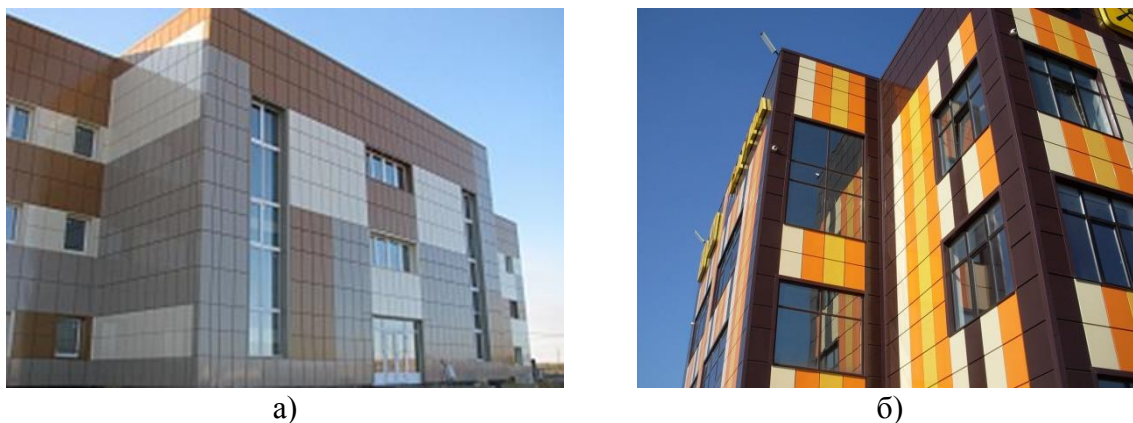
Фасады зданий: а) облицовка фасада сэндвич панелями; б) облицовка фасадными кассетами
